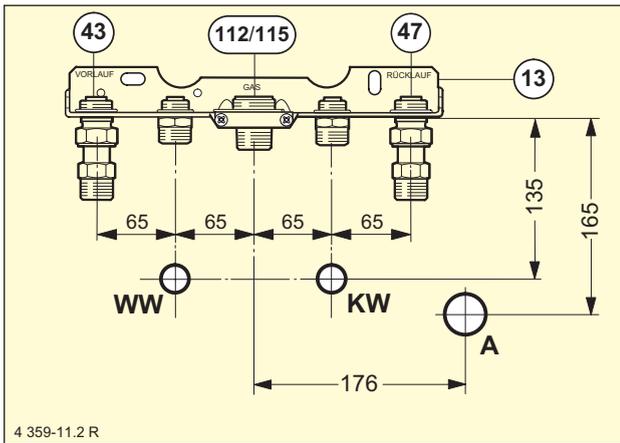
Aufputzanschlüsse mit Wandabstand 60 mm
